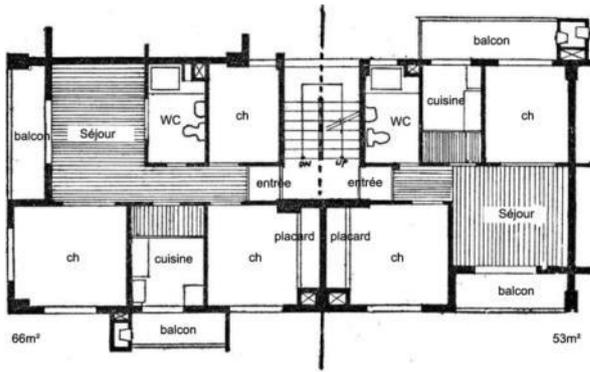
Plan d'unité d'Inwang *ap'at'ũ*.
